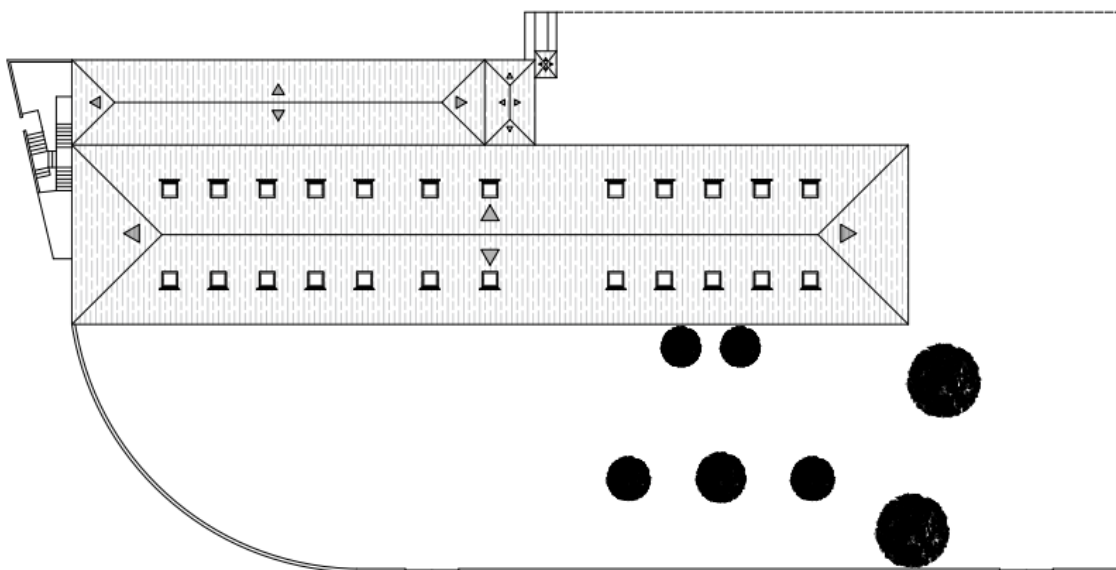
Planta de Cobertura, Restaurante e Alojamento Olive
